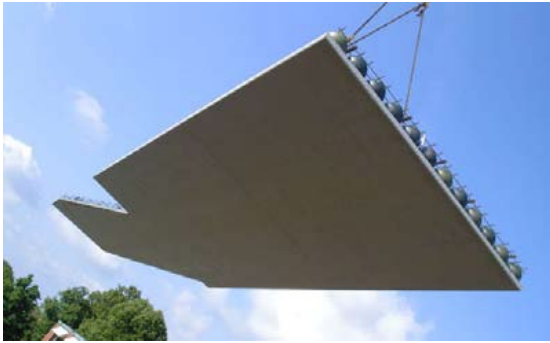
Hullplateelementene er bygget opp av en prefabrikkert betong bunnplate (filigranelement) med ferdigmontert armering og plastkuler ("Bobler") samt en overliggende del av plasstøpt betong
